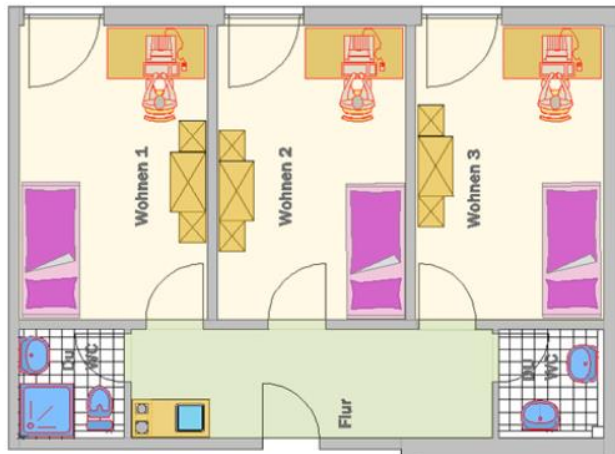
Grundriss Wohngemeinschaft Deggendorfer Studentenviertel [6]
